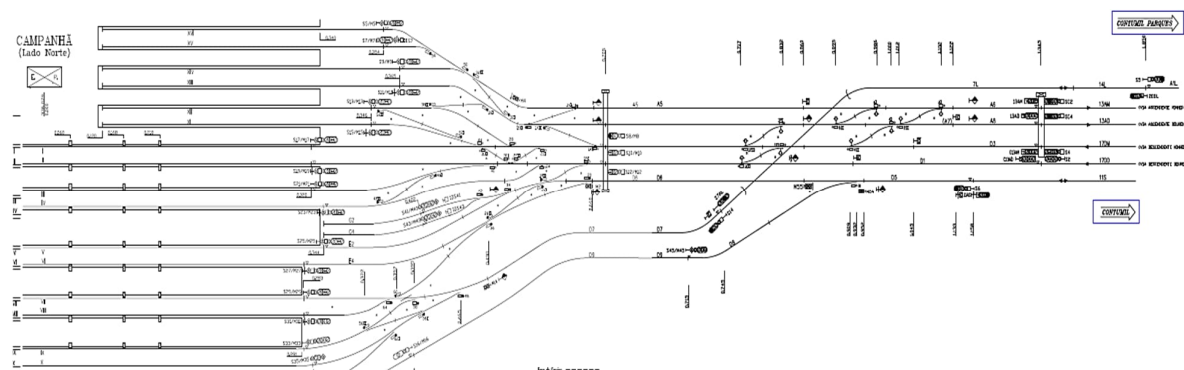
Estação de Campanhã – Situação Existente – Saída – Lado Norte
